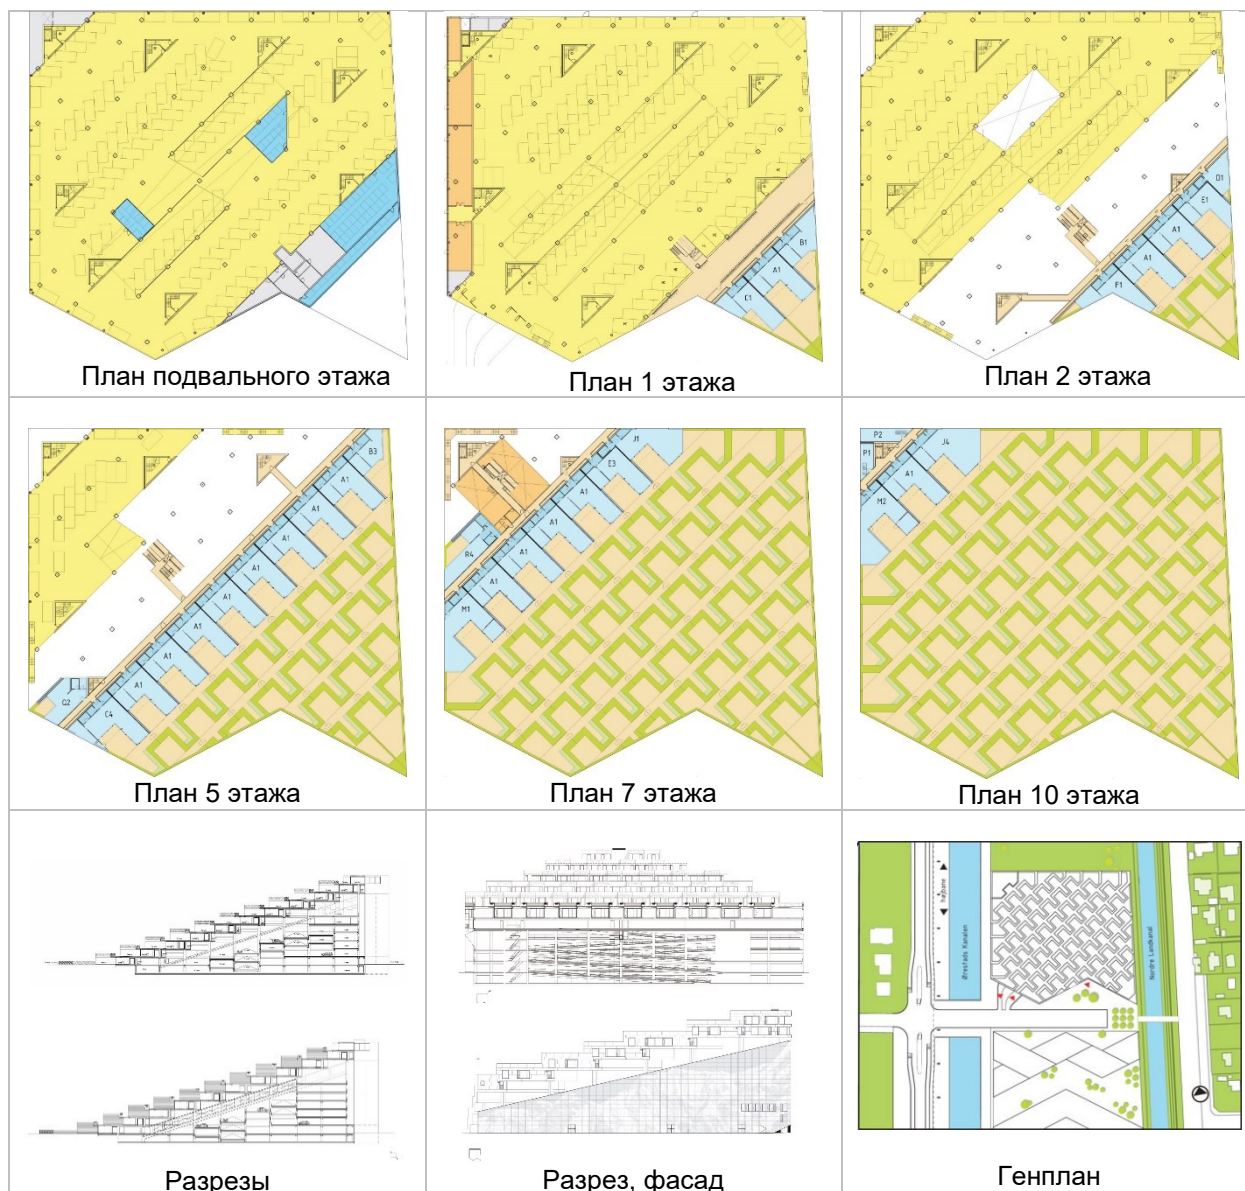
Чертежи – схемы планов, разрезы, фасад, генплан
